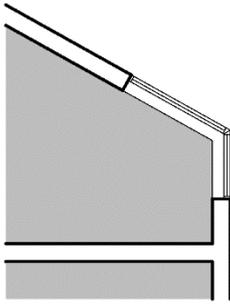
Fenêtre de toit articulée avec une fenêtre de façade
